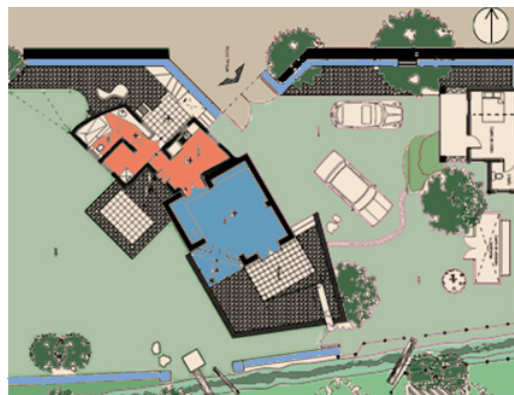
Planta arquitectónica de la Quinta El Dalai.
